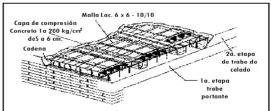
Losa Prefabricada. 2016. http://civilgeeks.com/wp-content/uploads/2013/02/TEchoMetalico-3D_1.png
